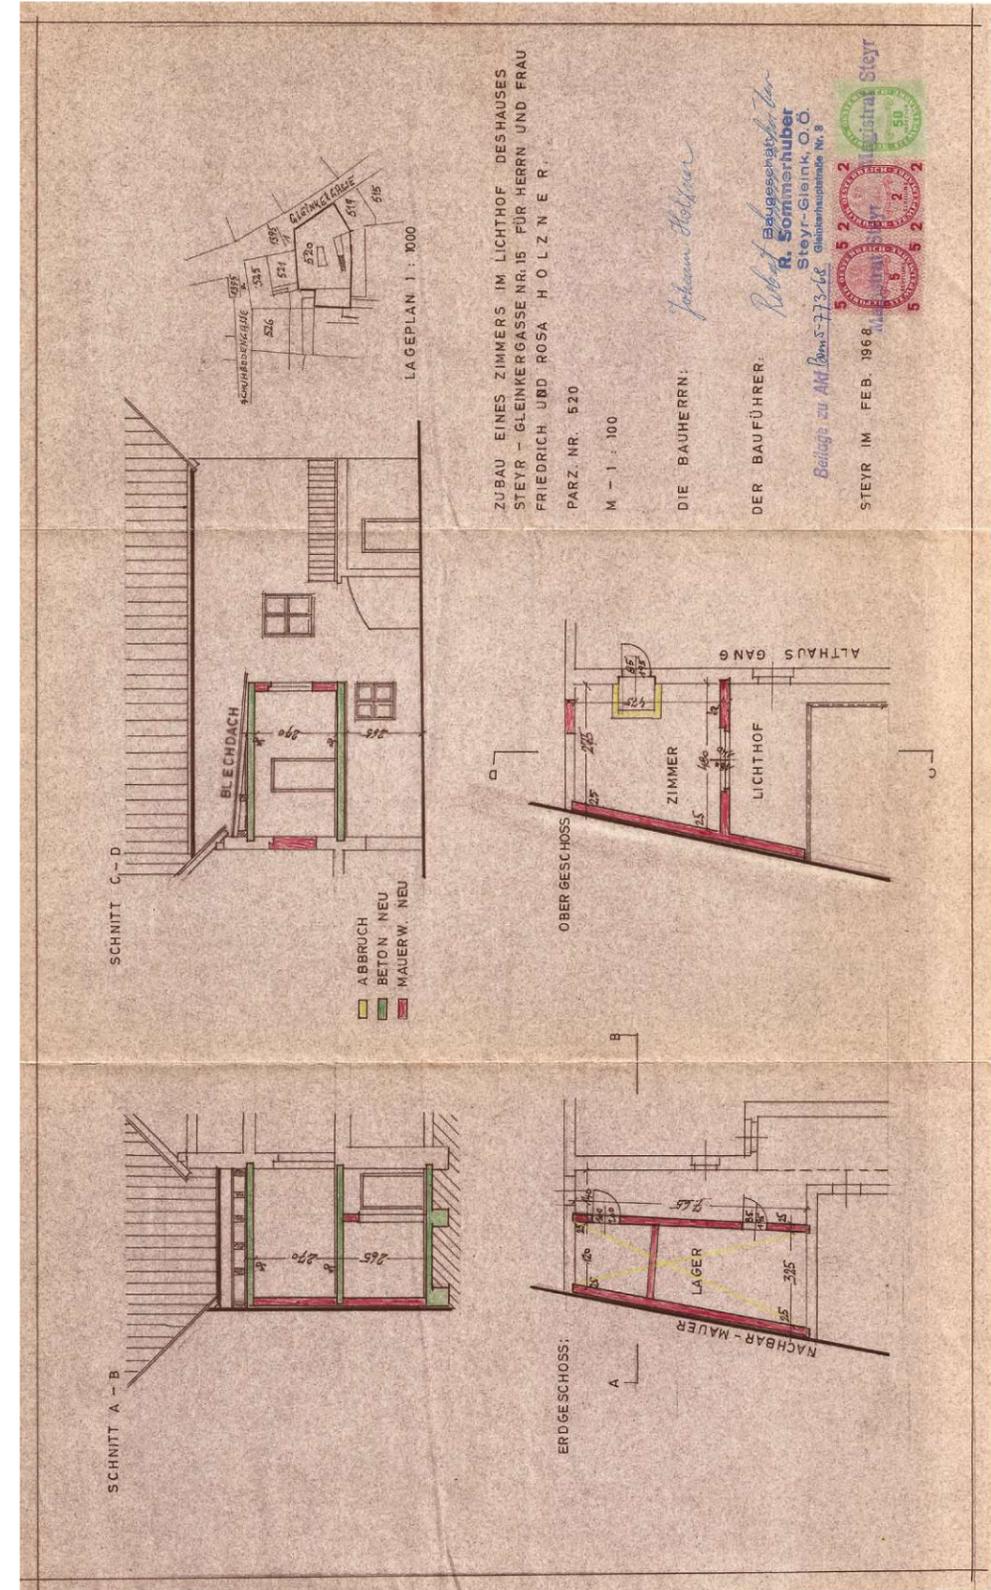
Plan für den Zubau eines Zimmers im Lichthof
